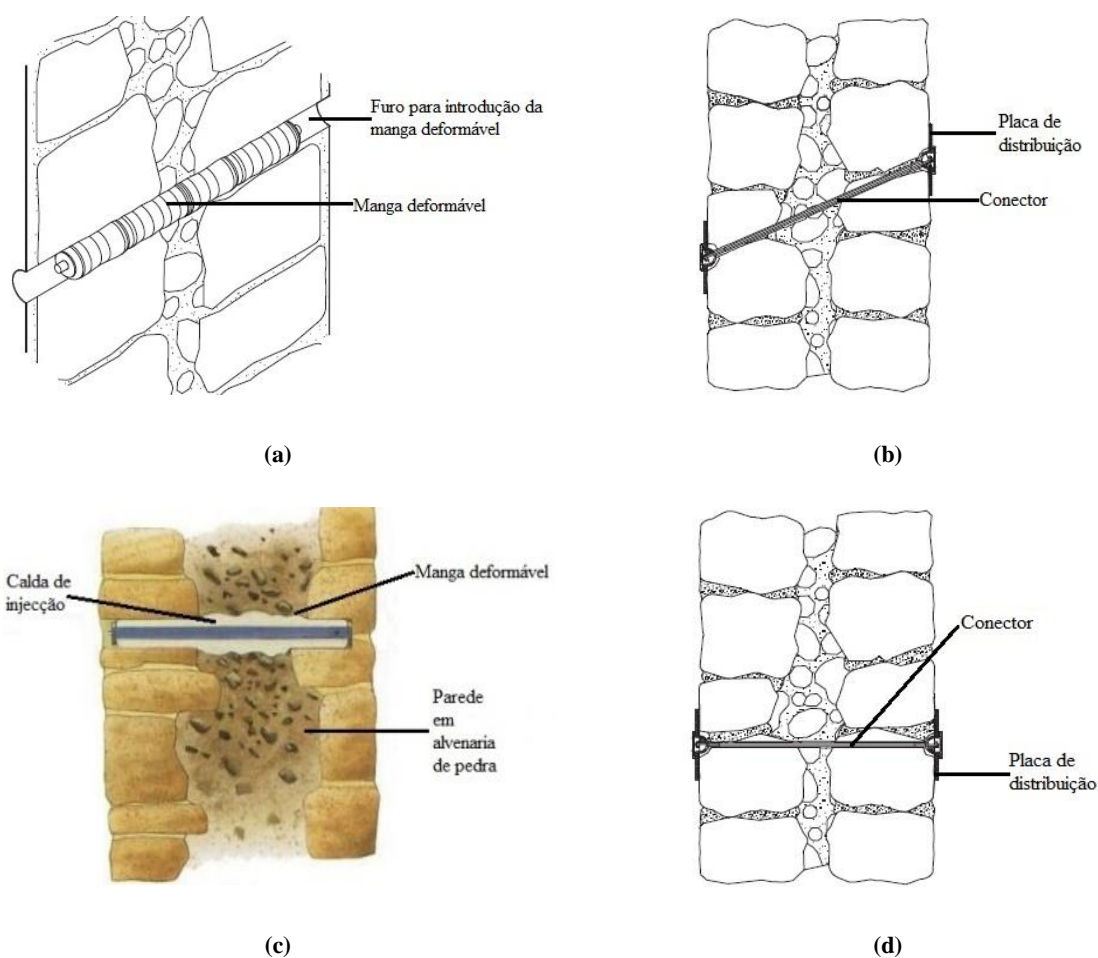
Conectores de confinamento (a) dotado de manga deformável; (b) diagonal apertado mecanicamente; (c) dotado de manga deformável; (d) horizontal apertado mecanicamente [Cóias, 2007]
